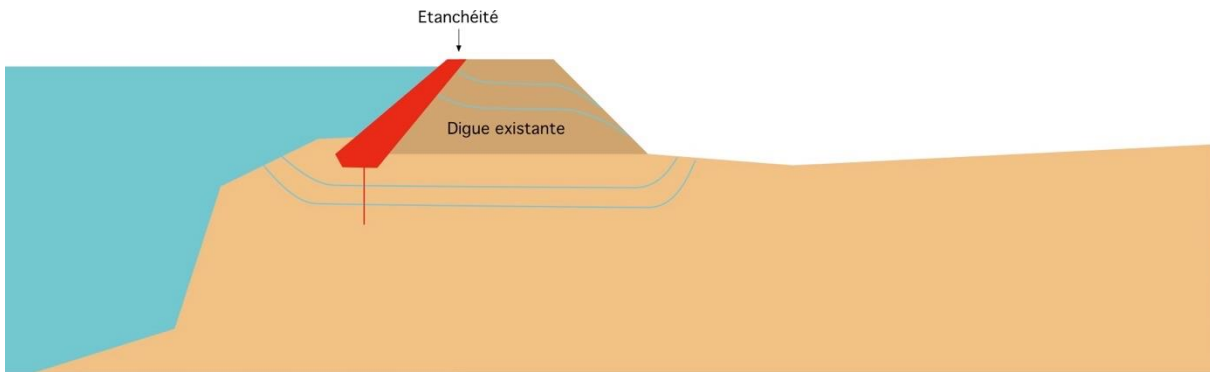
Étanchéité par massif étanche amont pour la digue et écran mince en fondation.
